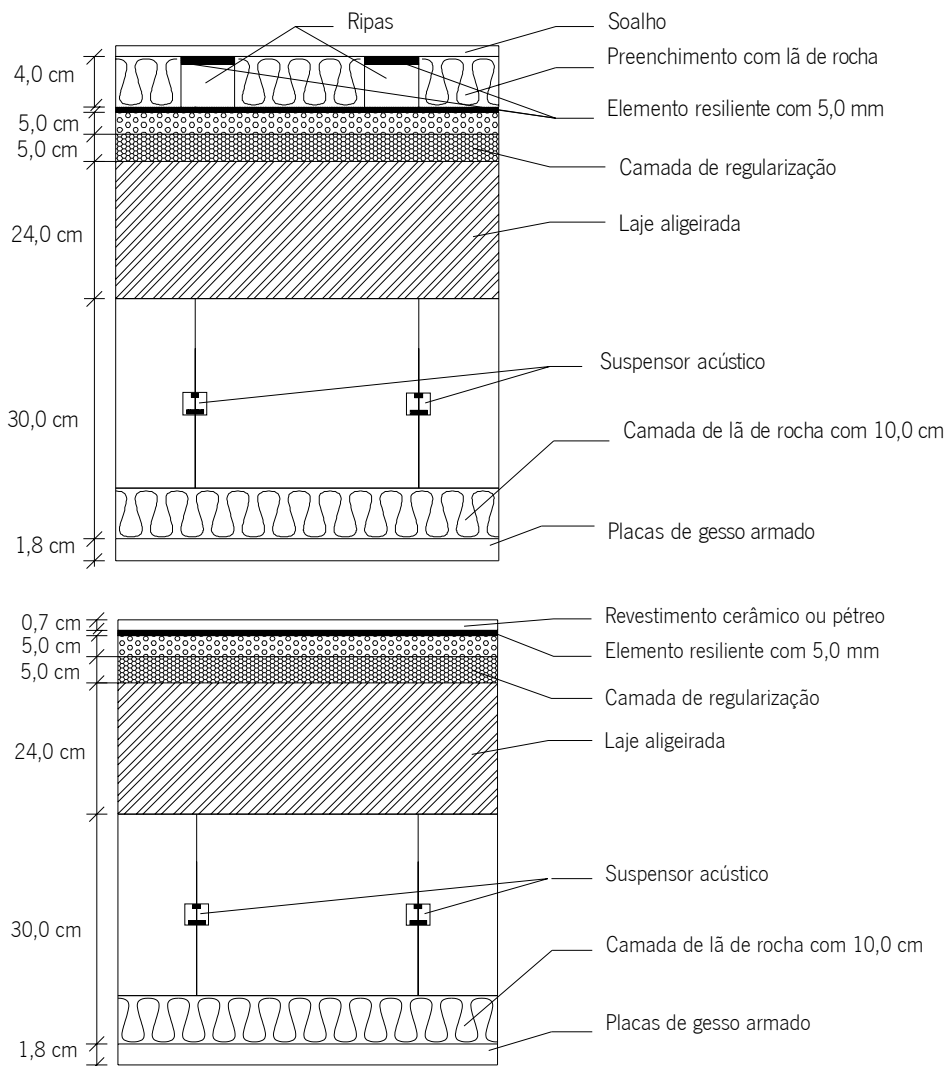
Pavimento de separação entre uma habitação e a zona de escritórios com soalho de madeira e com material cerâmico ou pétreo, Pav2
